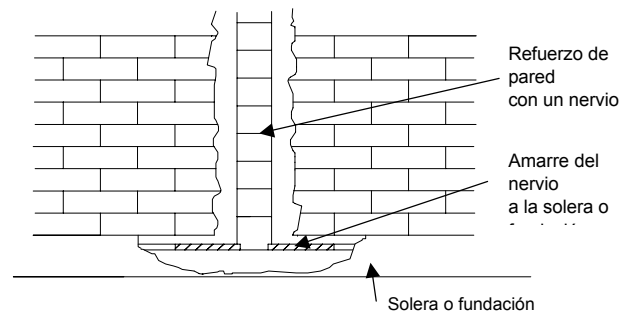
Refuerzo de pared con nervio(para grietas > 10mm)
